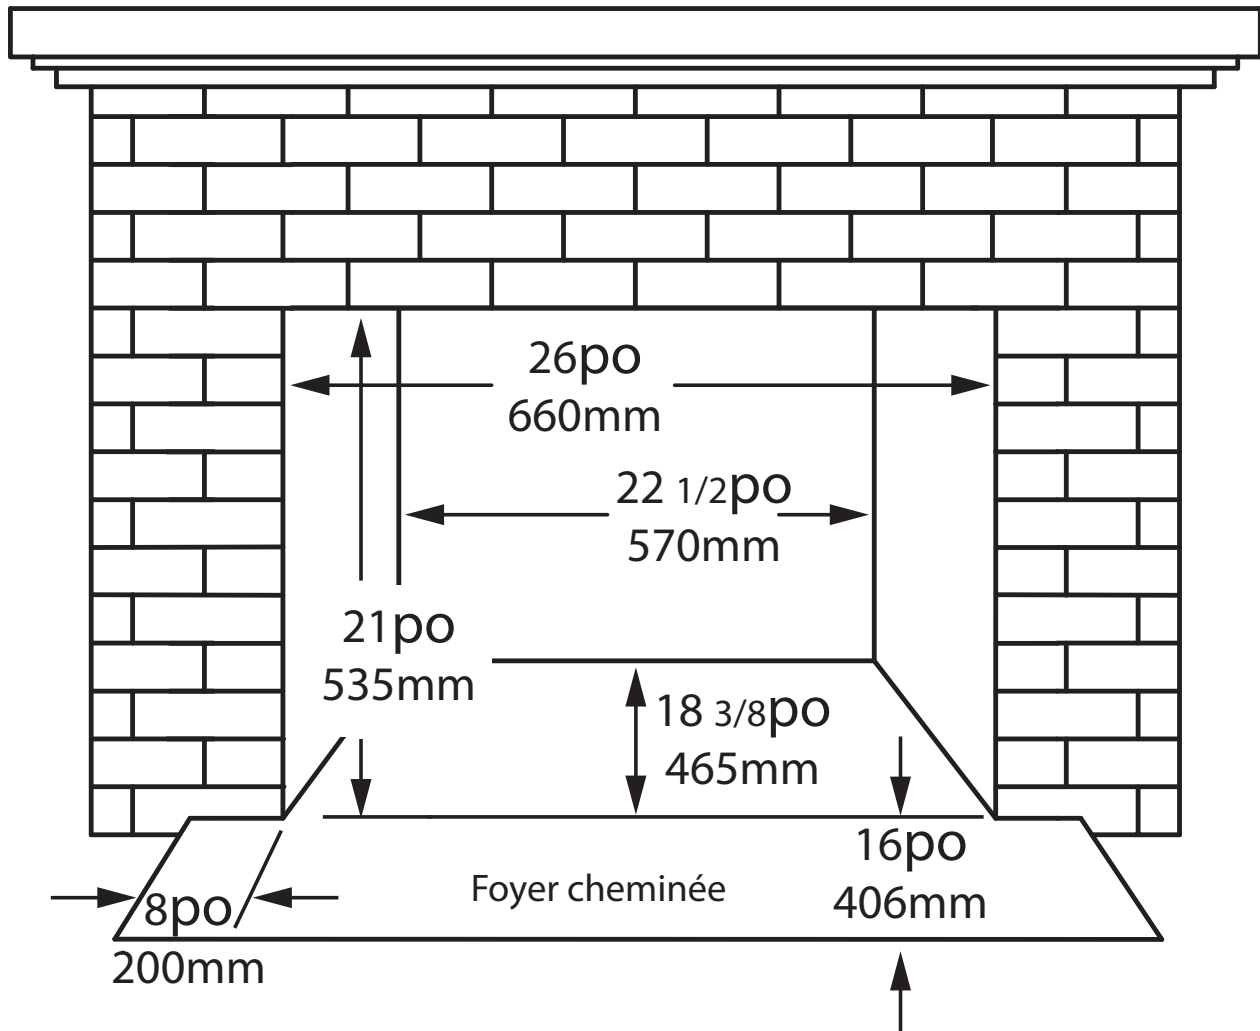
Ouverture de cheminée dim. - Insert ALT5 LE.
